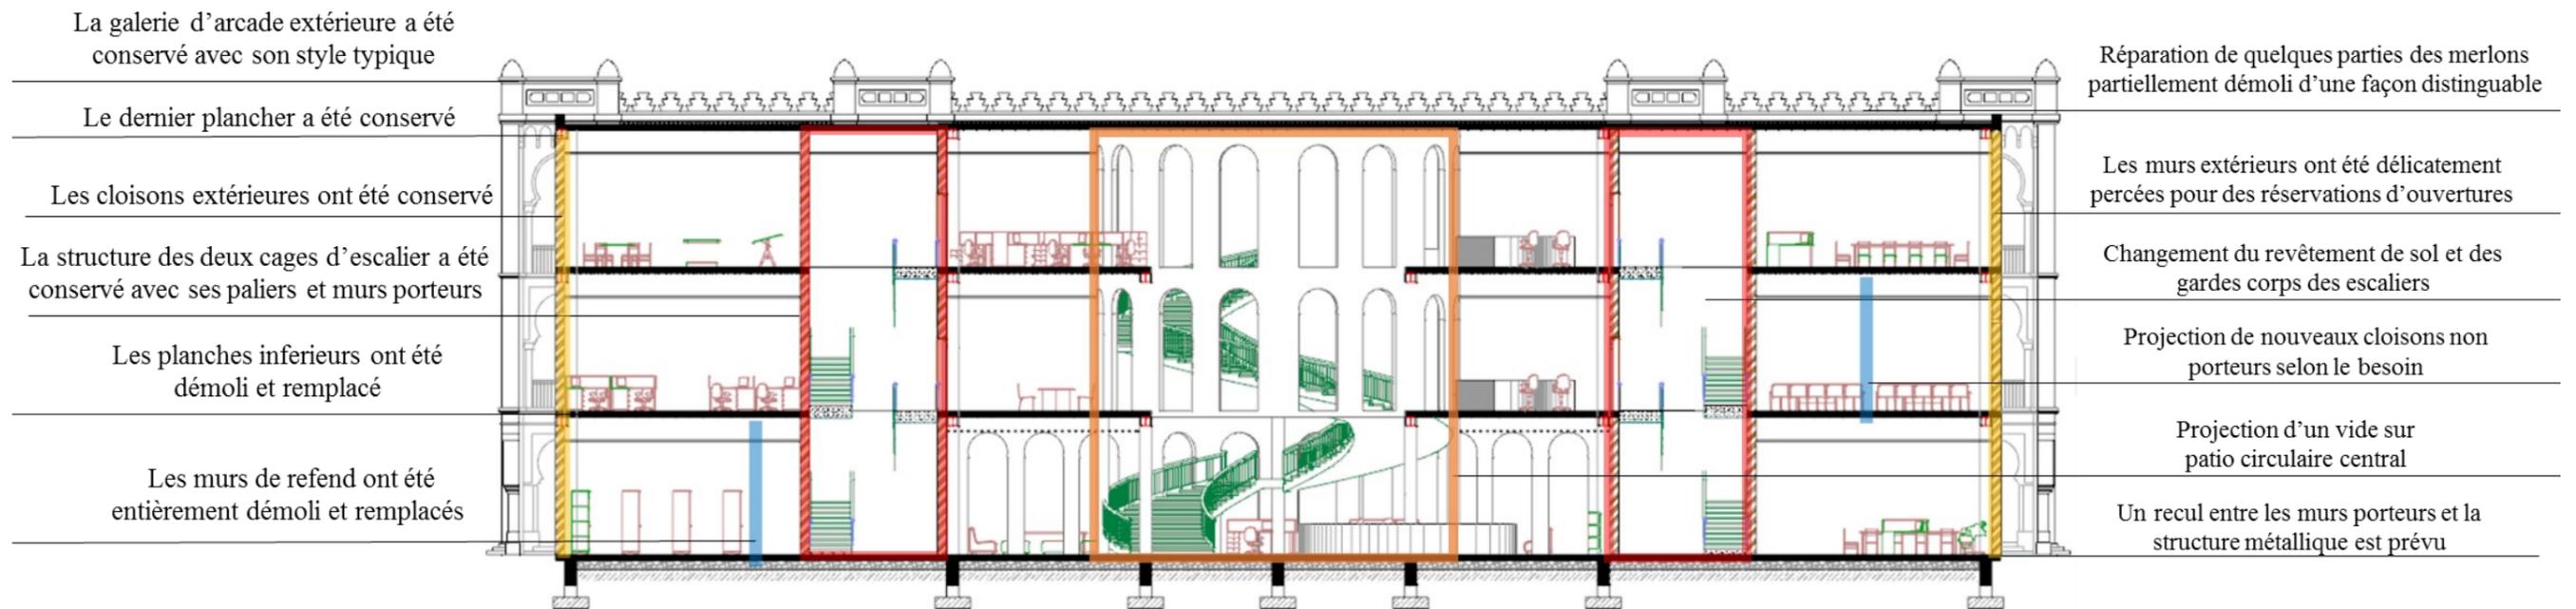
Coupe montrant les différentes actions d'intervention sur l'entité A
